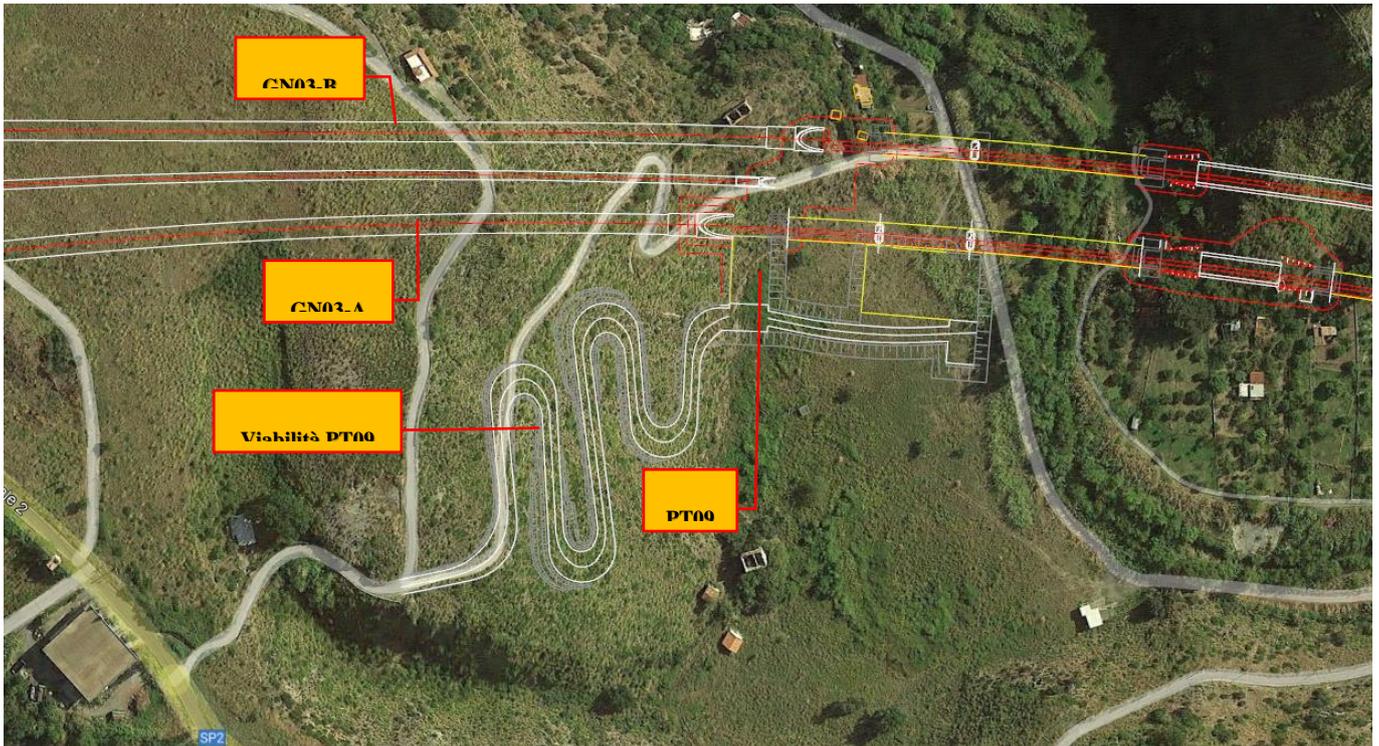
Planimetria con individuazione della nuova viabilità PT09
